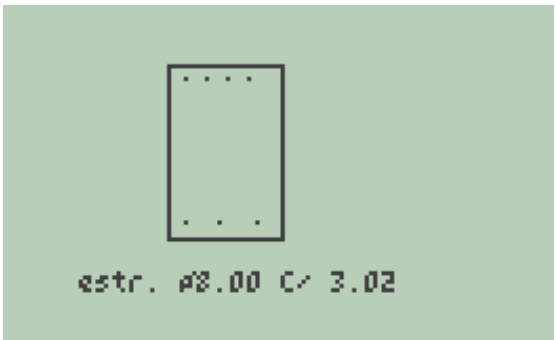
Sapatas Associadas - Detalhamento da viga, estribos.
